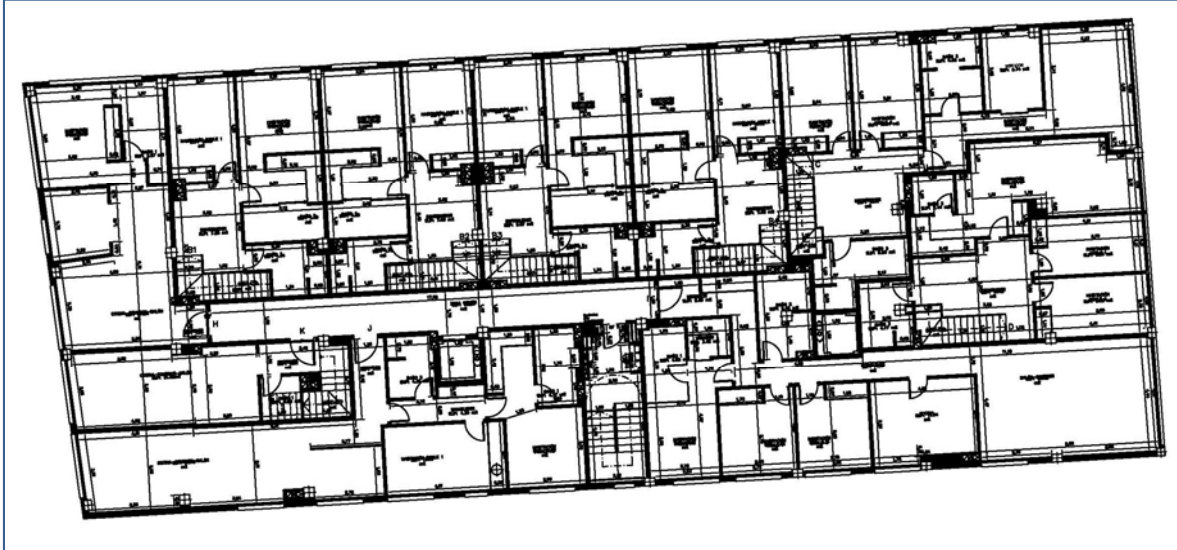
Plano de planta primera. Procede del Proyecto de Ejecución.
